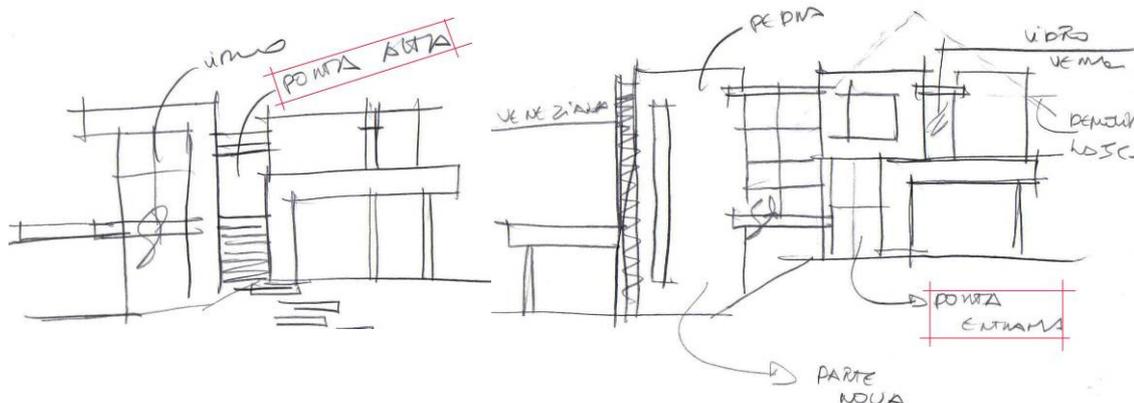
Croquis das fachadas (frontal e lateral Sudeste)
